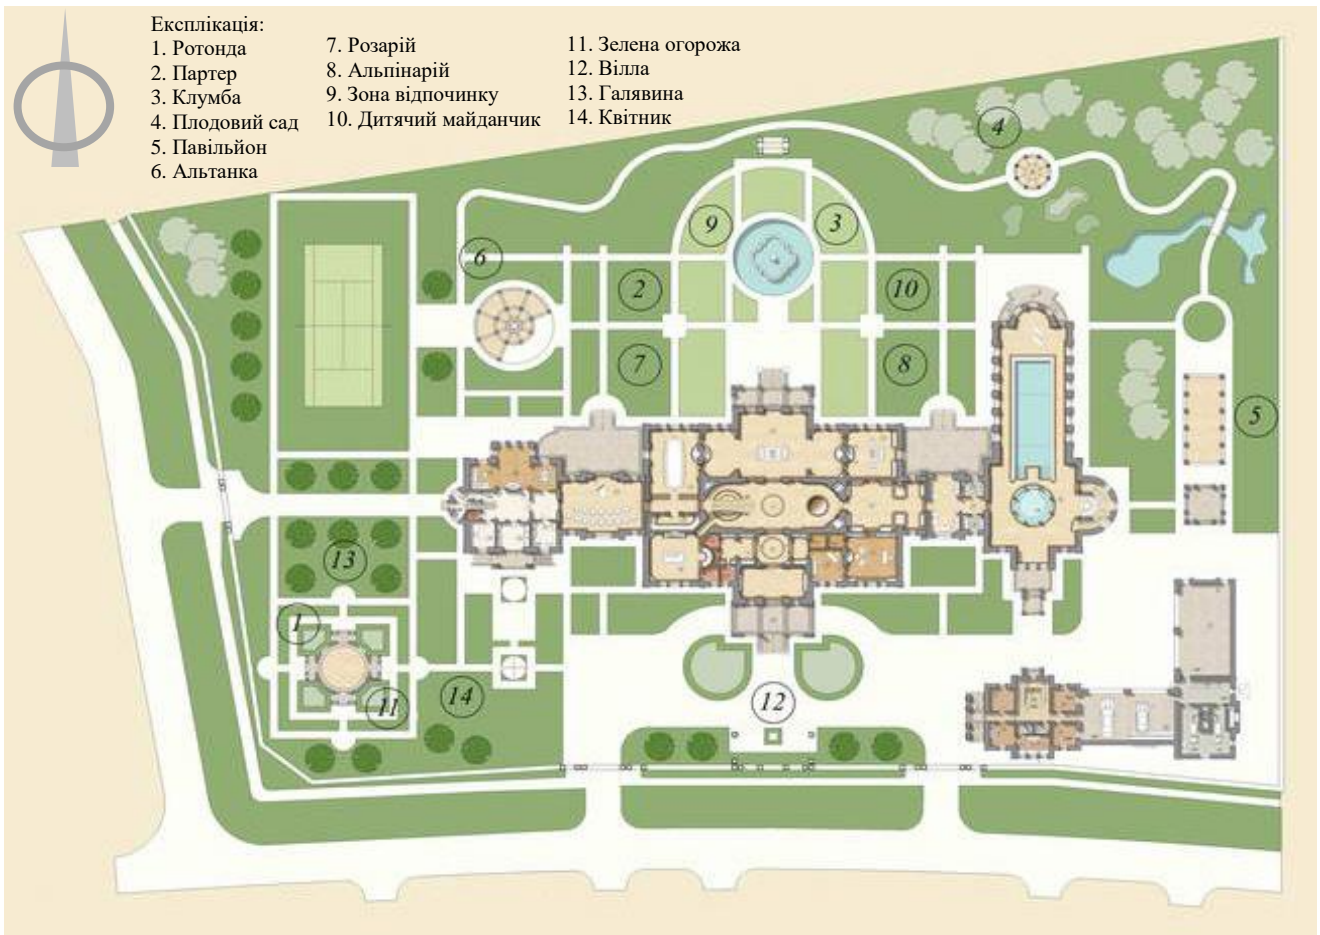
Приклади оформлення схеми генерального плану
